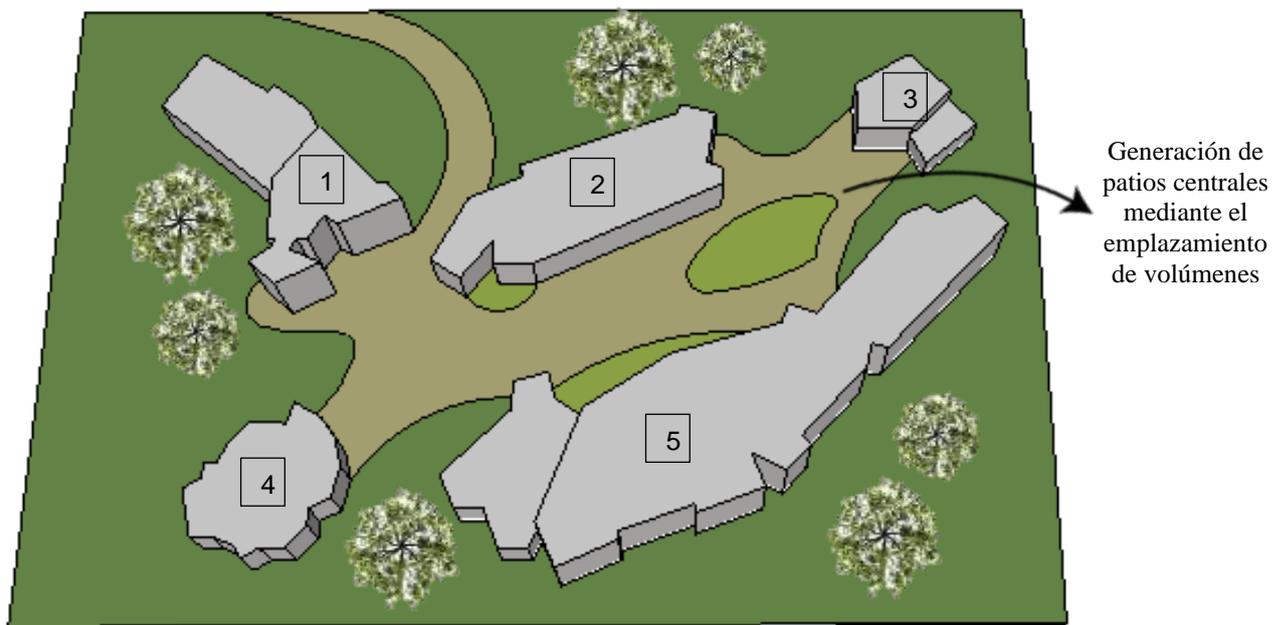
Vista de emplazamiento del proyecto - Caso analizado VI
